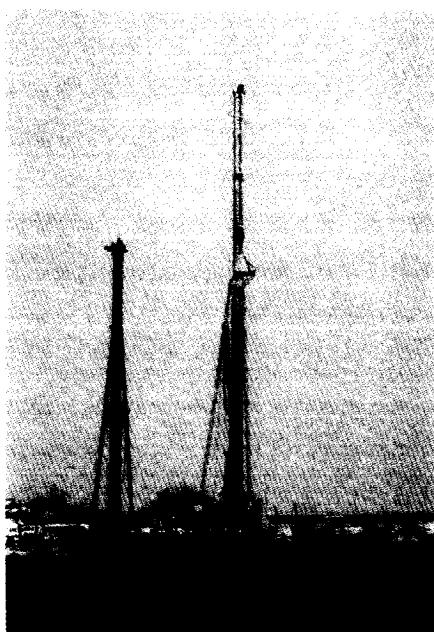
サンドコンパクションパイル工法（中部地方建設局）
